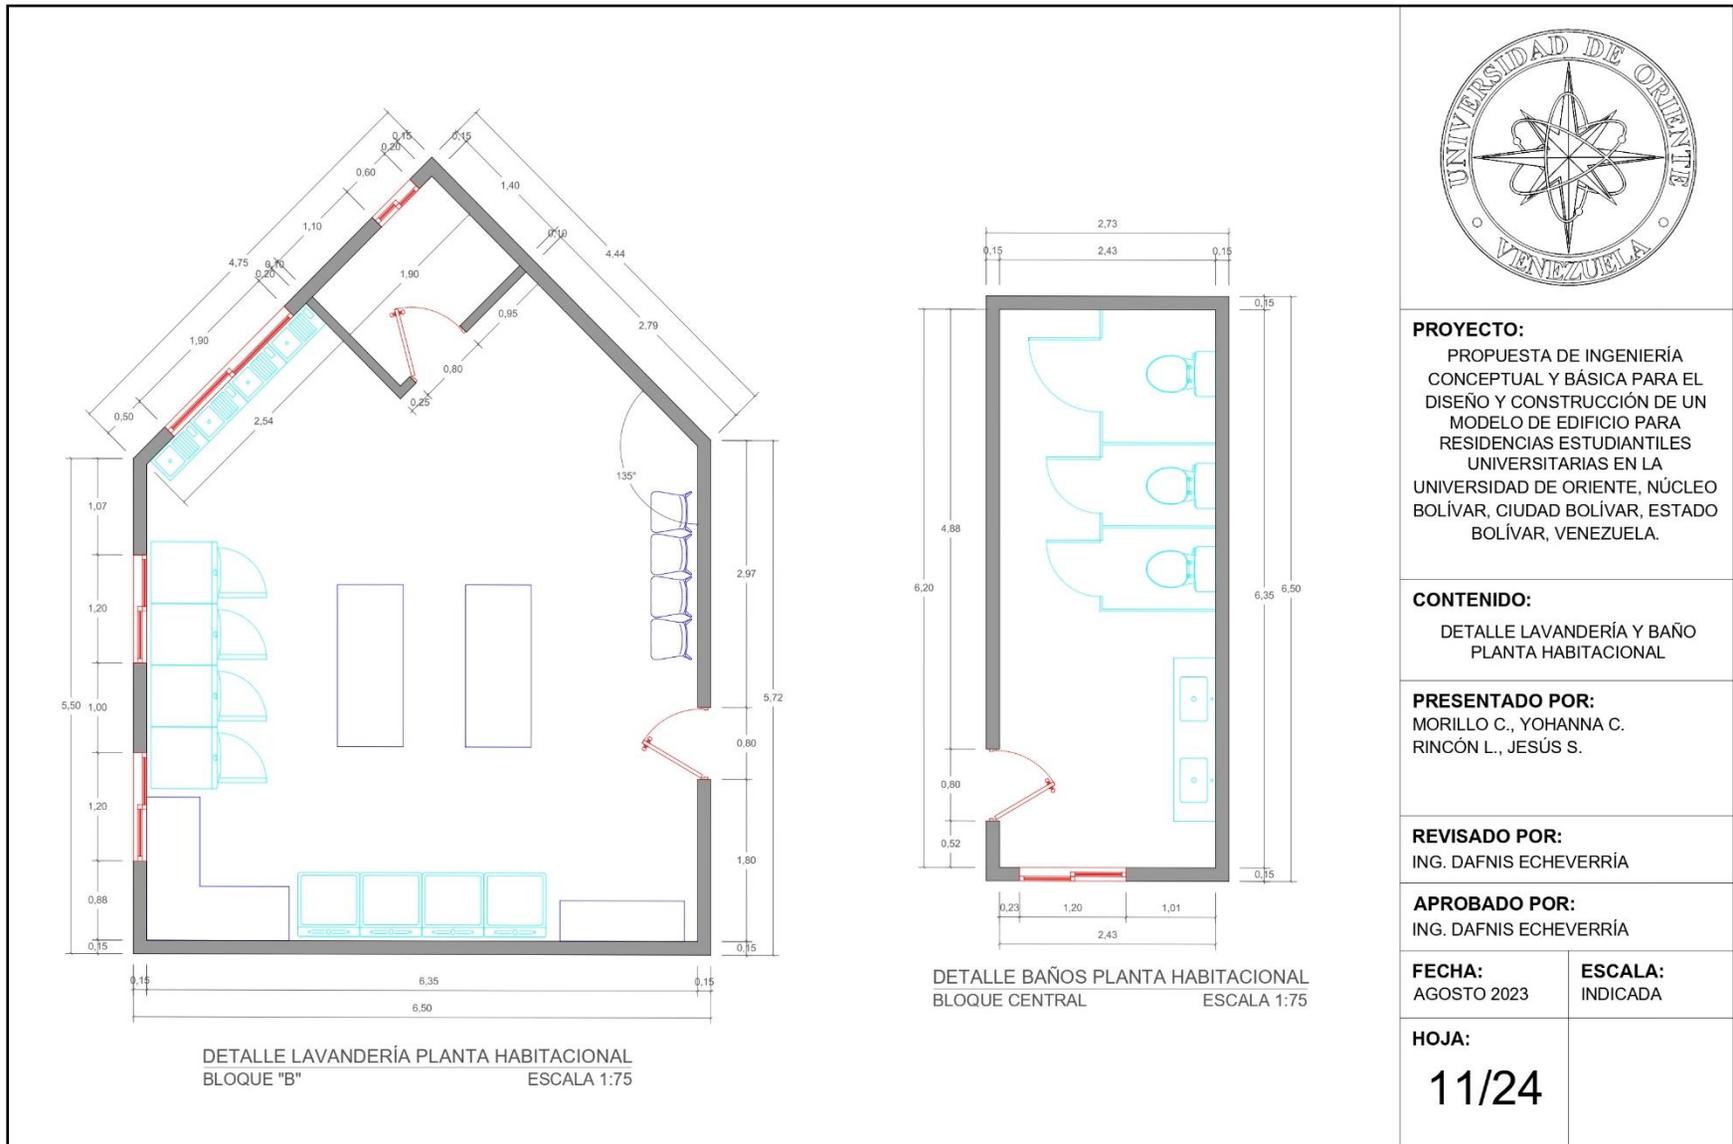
Plano de Detalle. Lavandería, planta habitacional.
